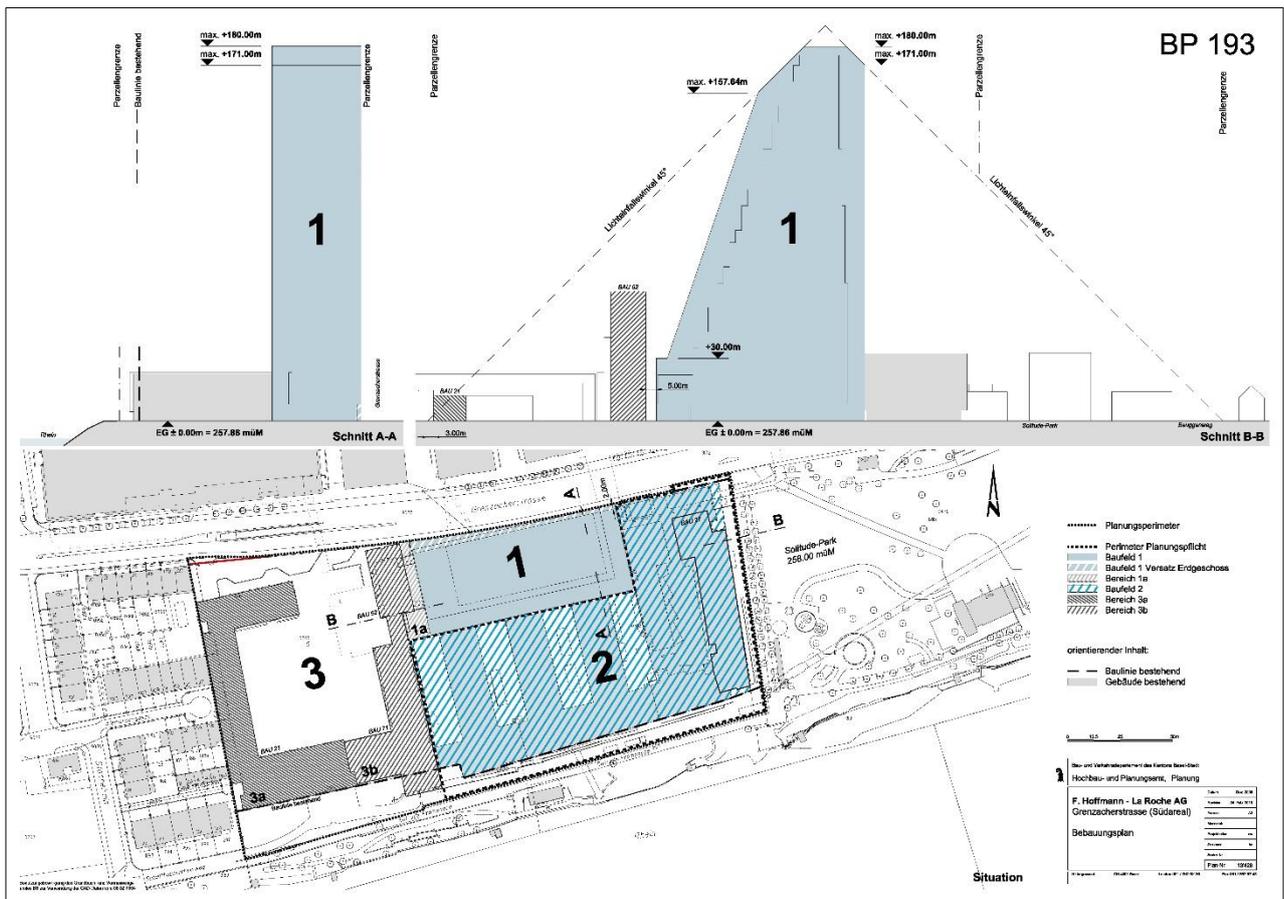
Bestehender Bebauungsplan Nr. 193. (Kein Massstab, Plan genordet)
